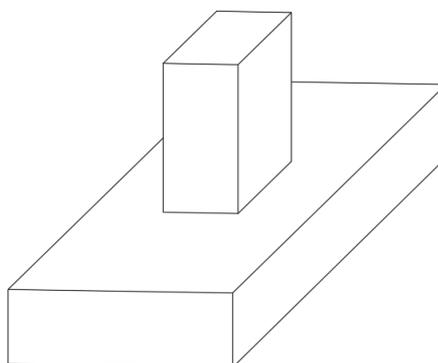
Diseño de la estructura de la zapata y el enano. Fuente: Elaboración propia.
